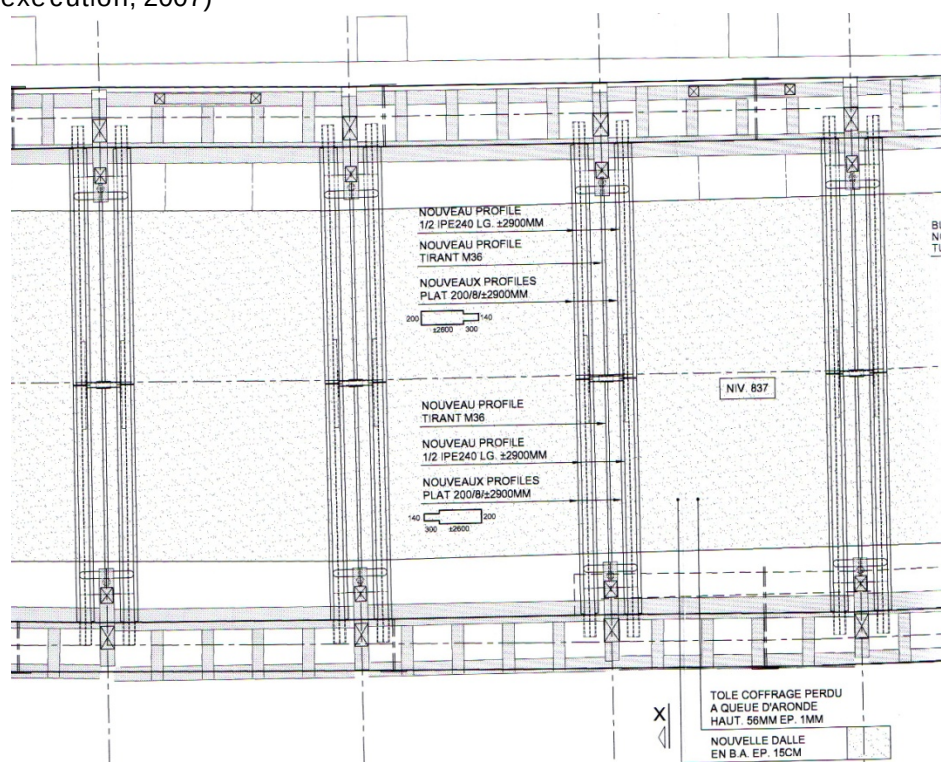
Vue en plan des travées formées par les nouveaux profilés (Plans-d'exécution, 2007)
